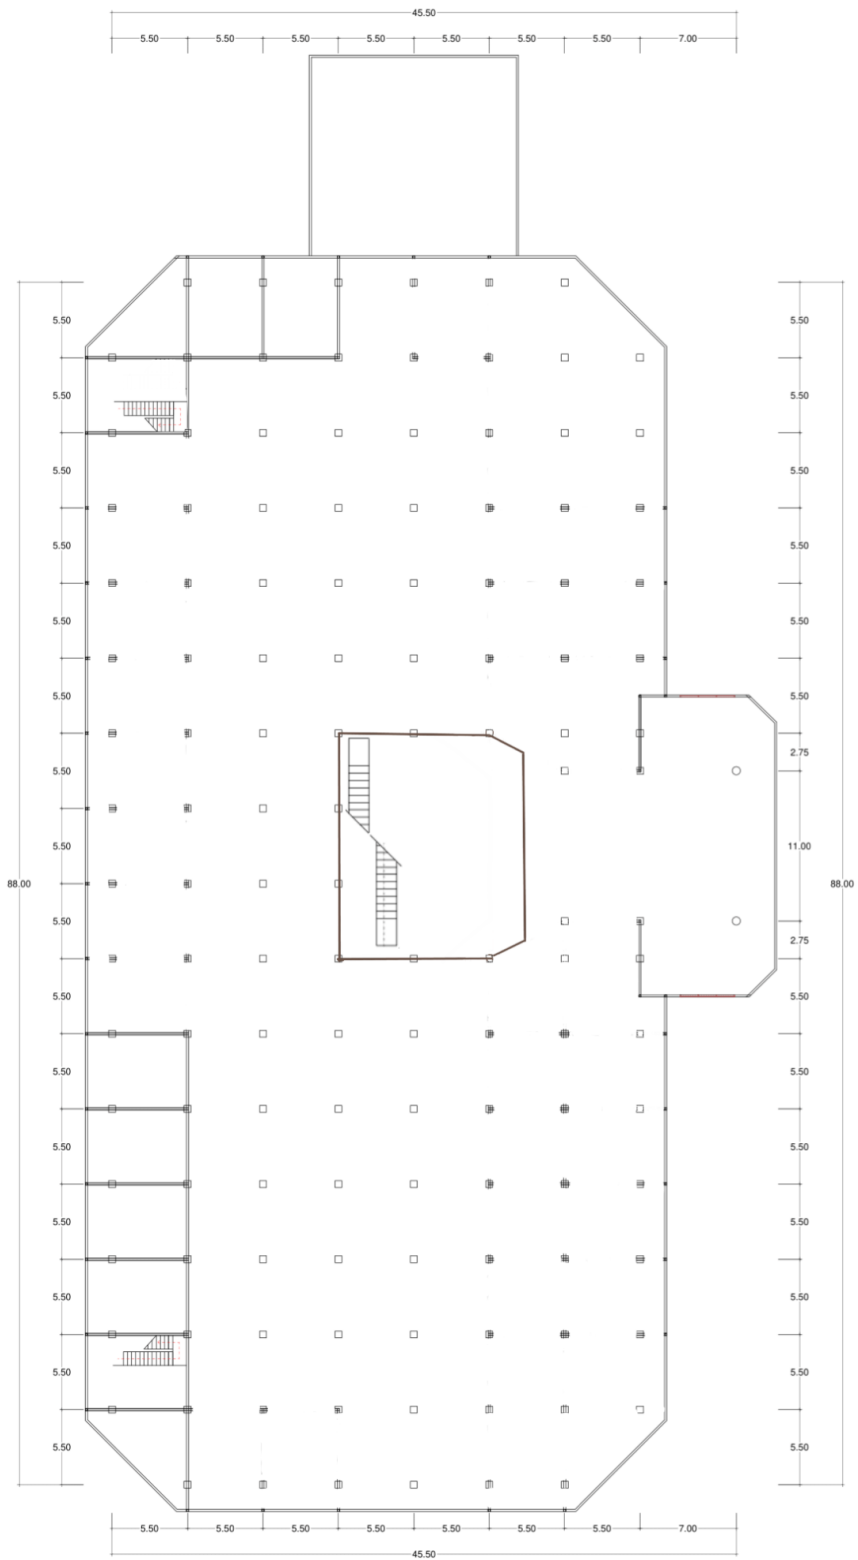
6 Denah Lantai Dasar Plasa Klaten
